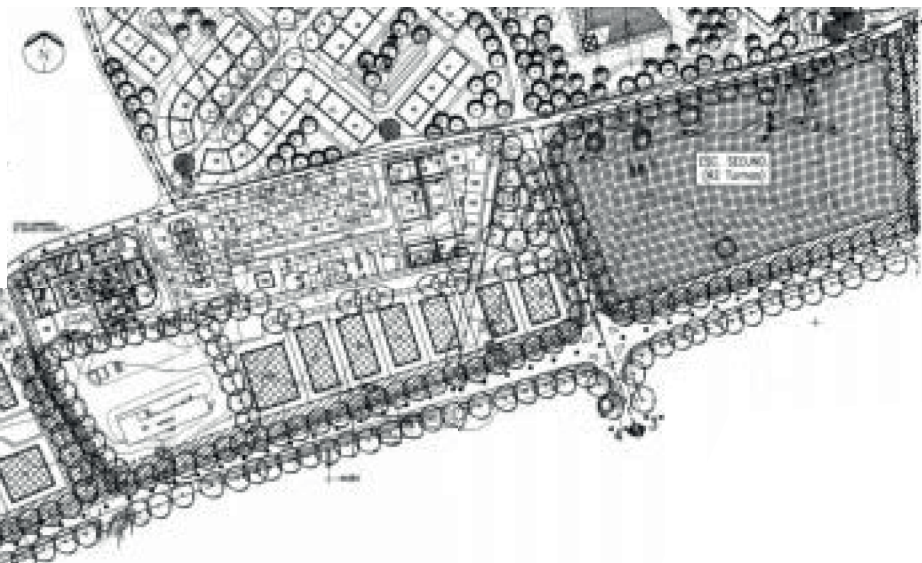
| Planta de Implantação, Plano de Pormenor de Vialonga, Planta 2.
